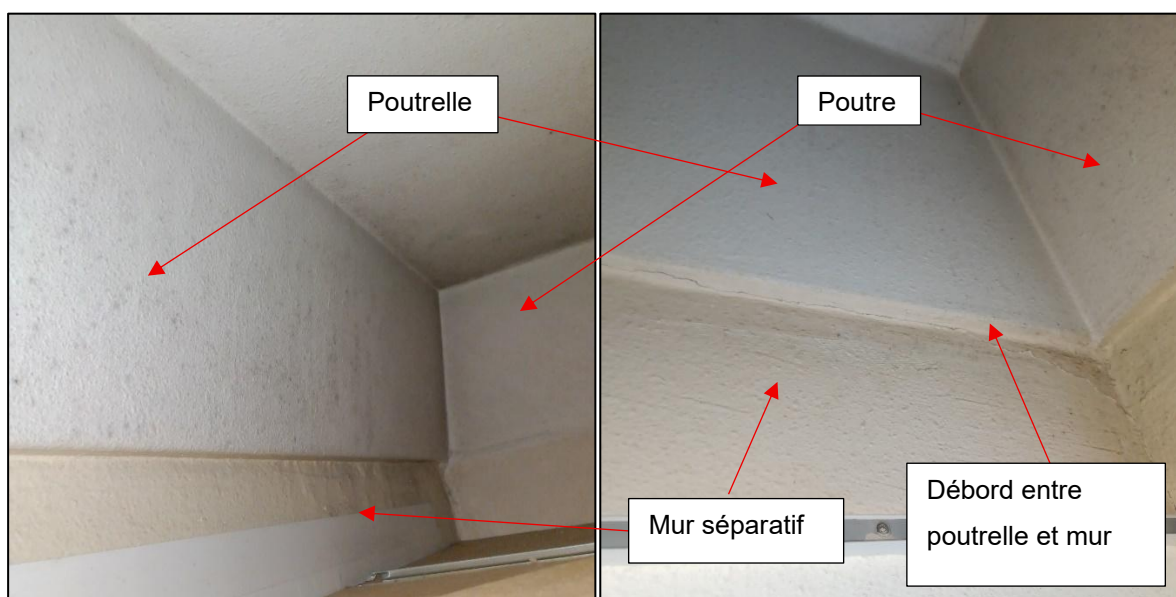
Vue sur le débord entre poutrelle et mur séparatif
